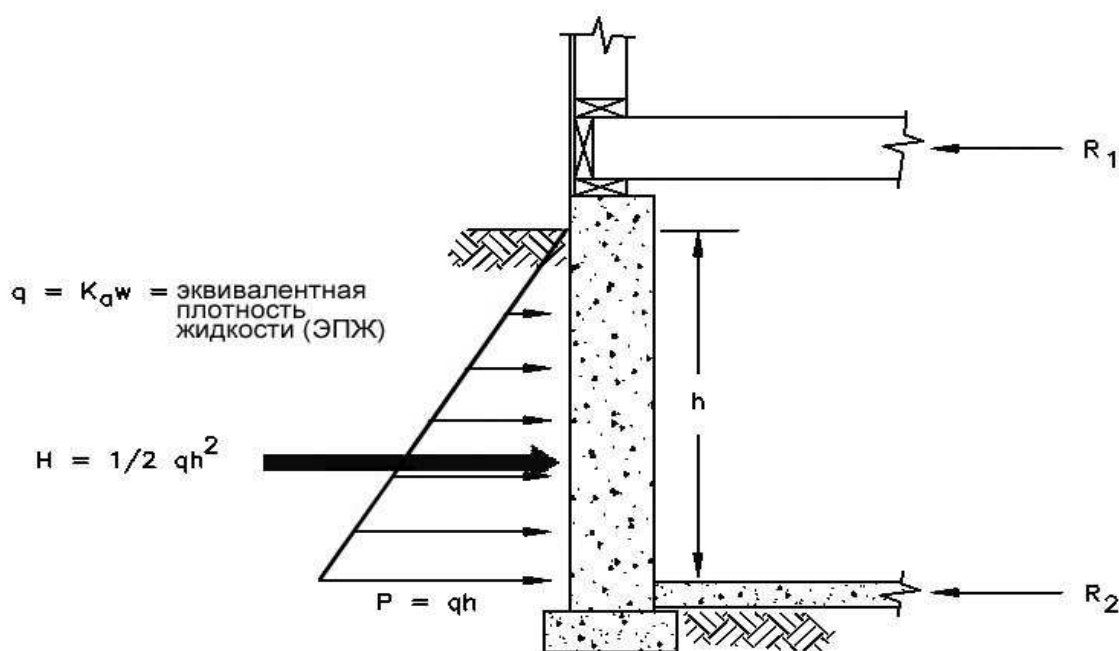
Эпюра бокового давления грунта на стену фундамента
